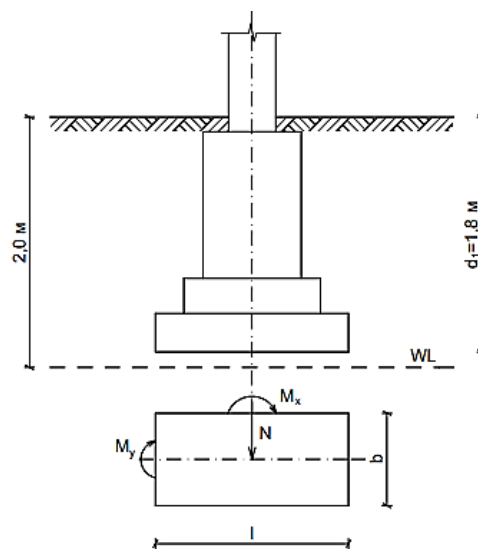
Схема розташування фундаменту у ґрунті і навантажень на фундамент
